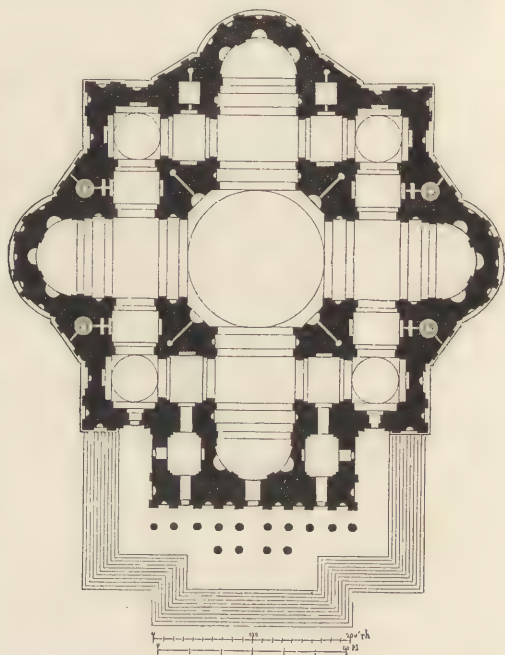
St. Peter. Michelangelo's Grundriss.
